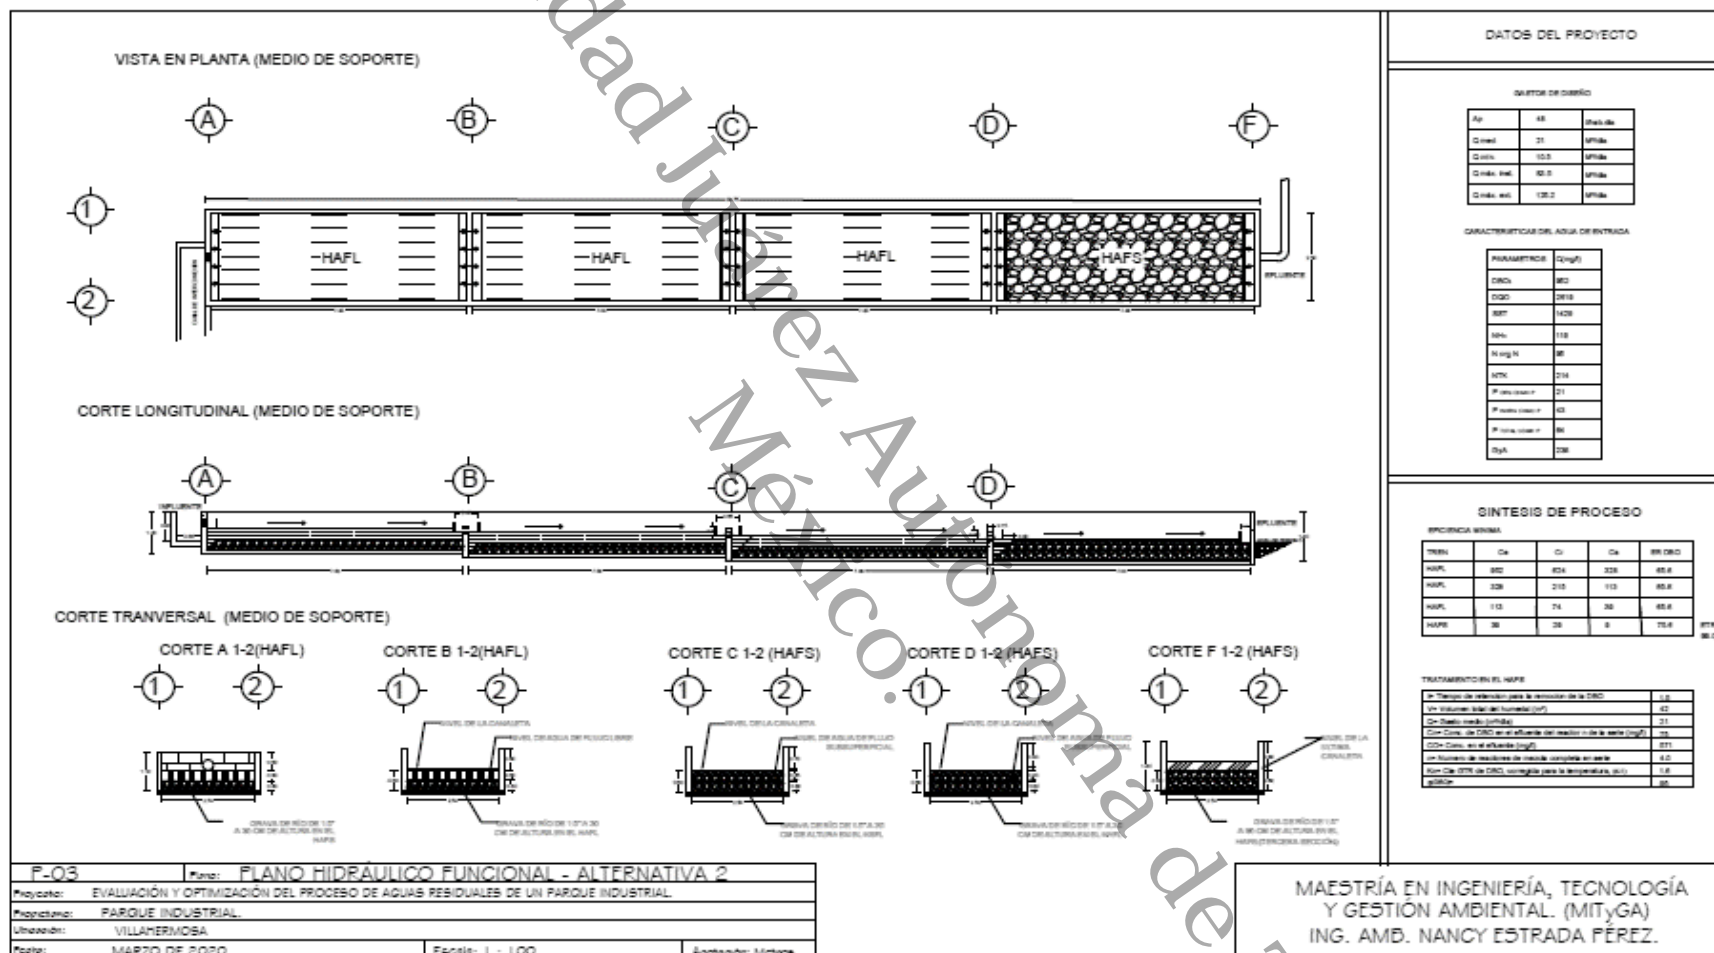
Tren de tratamiento vista en planta (Medio de soporte).
